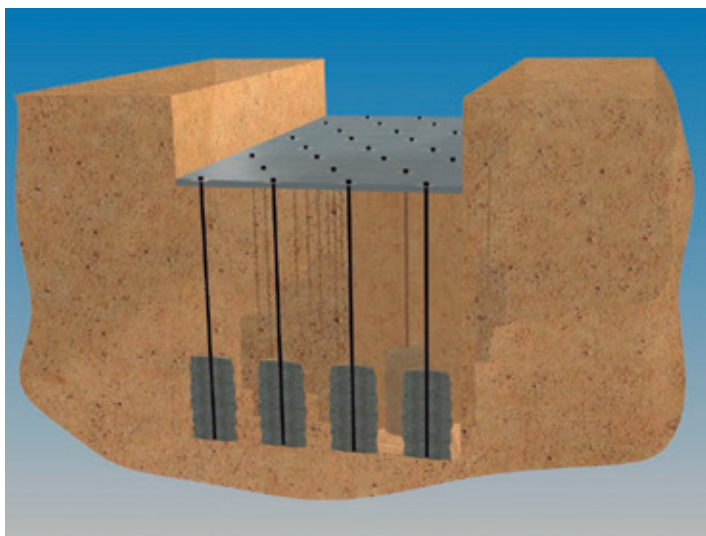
Ancoragens Verticais para lajes de subpressão.
